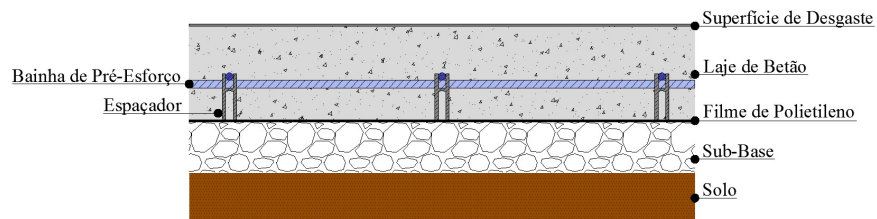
Esquema ilustrativo de um pavimento de betão pré-esforçado (Adaptado de João, C., 2014)
